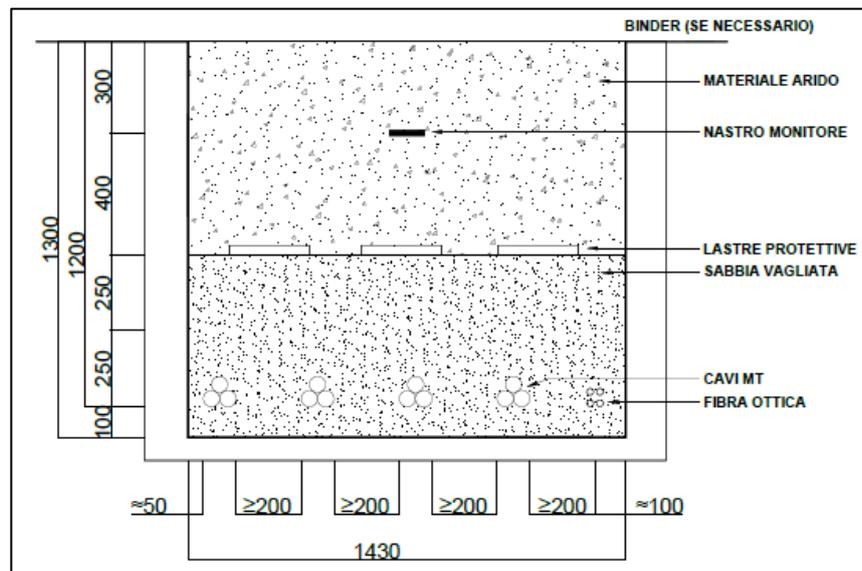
Sezione tipica del cavidotto con 4 cavi
